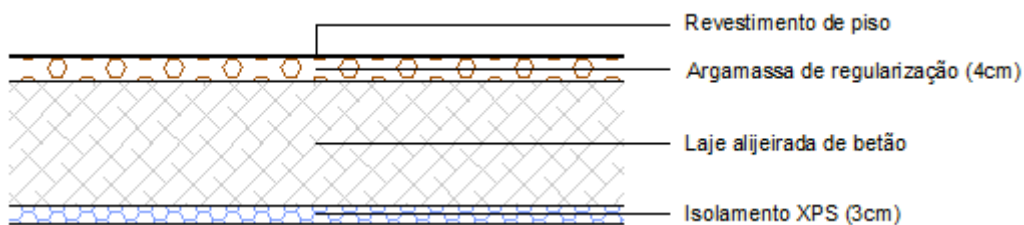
Pormenor construtivo de pavimentos sobre espaços não úteis
